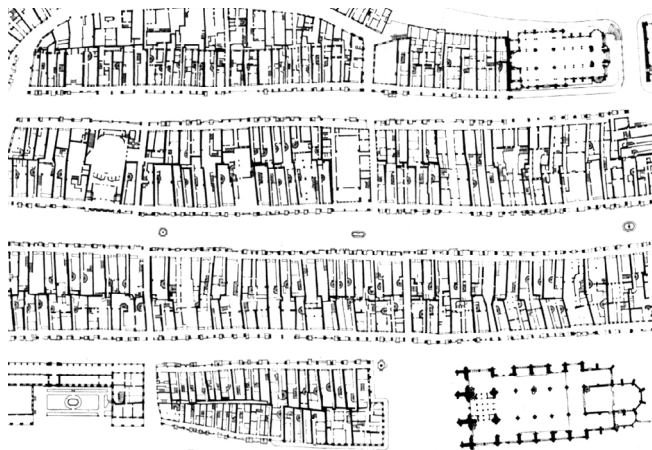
Ausschnitt Grundrissplan Erdgeschoss, Paul Hofer, TAD Archiv Bern 1975.
